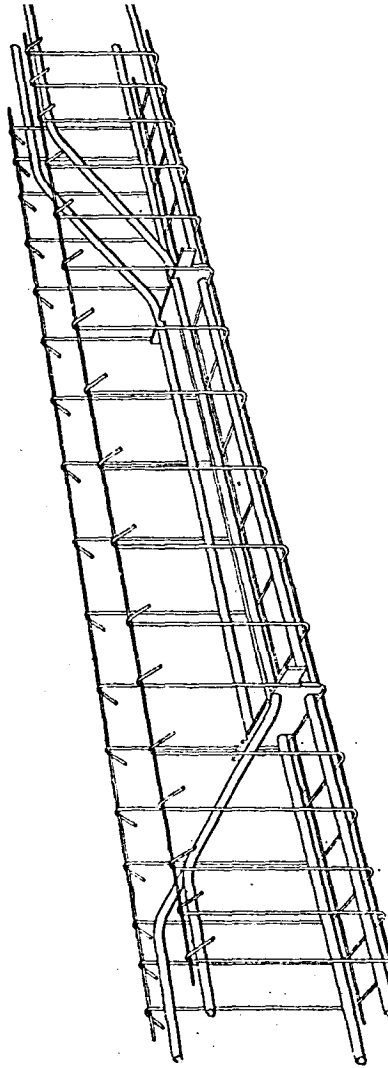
混凝土鋼件公司之可拆卸單位鋼筋架
